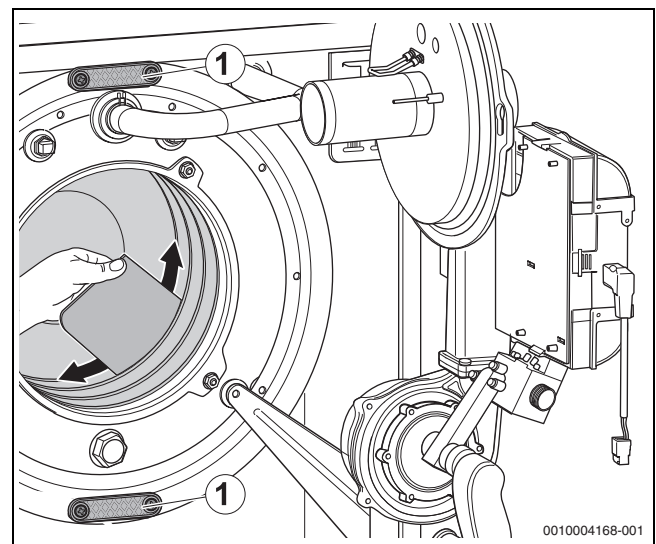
Heizgasspalte mit Reinigungsspachtel reinigen
